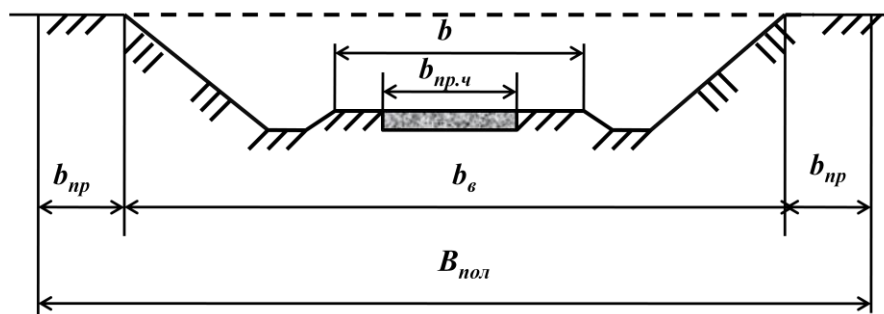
Схема к определению ширины полосы отвода для выемок
